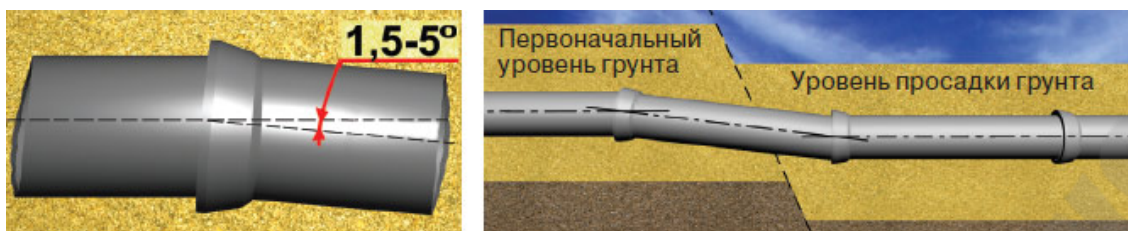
Предельные смещения секций чугунных трубопроводов
